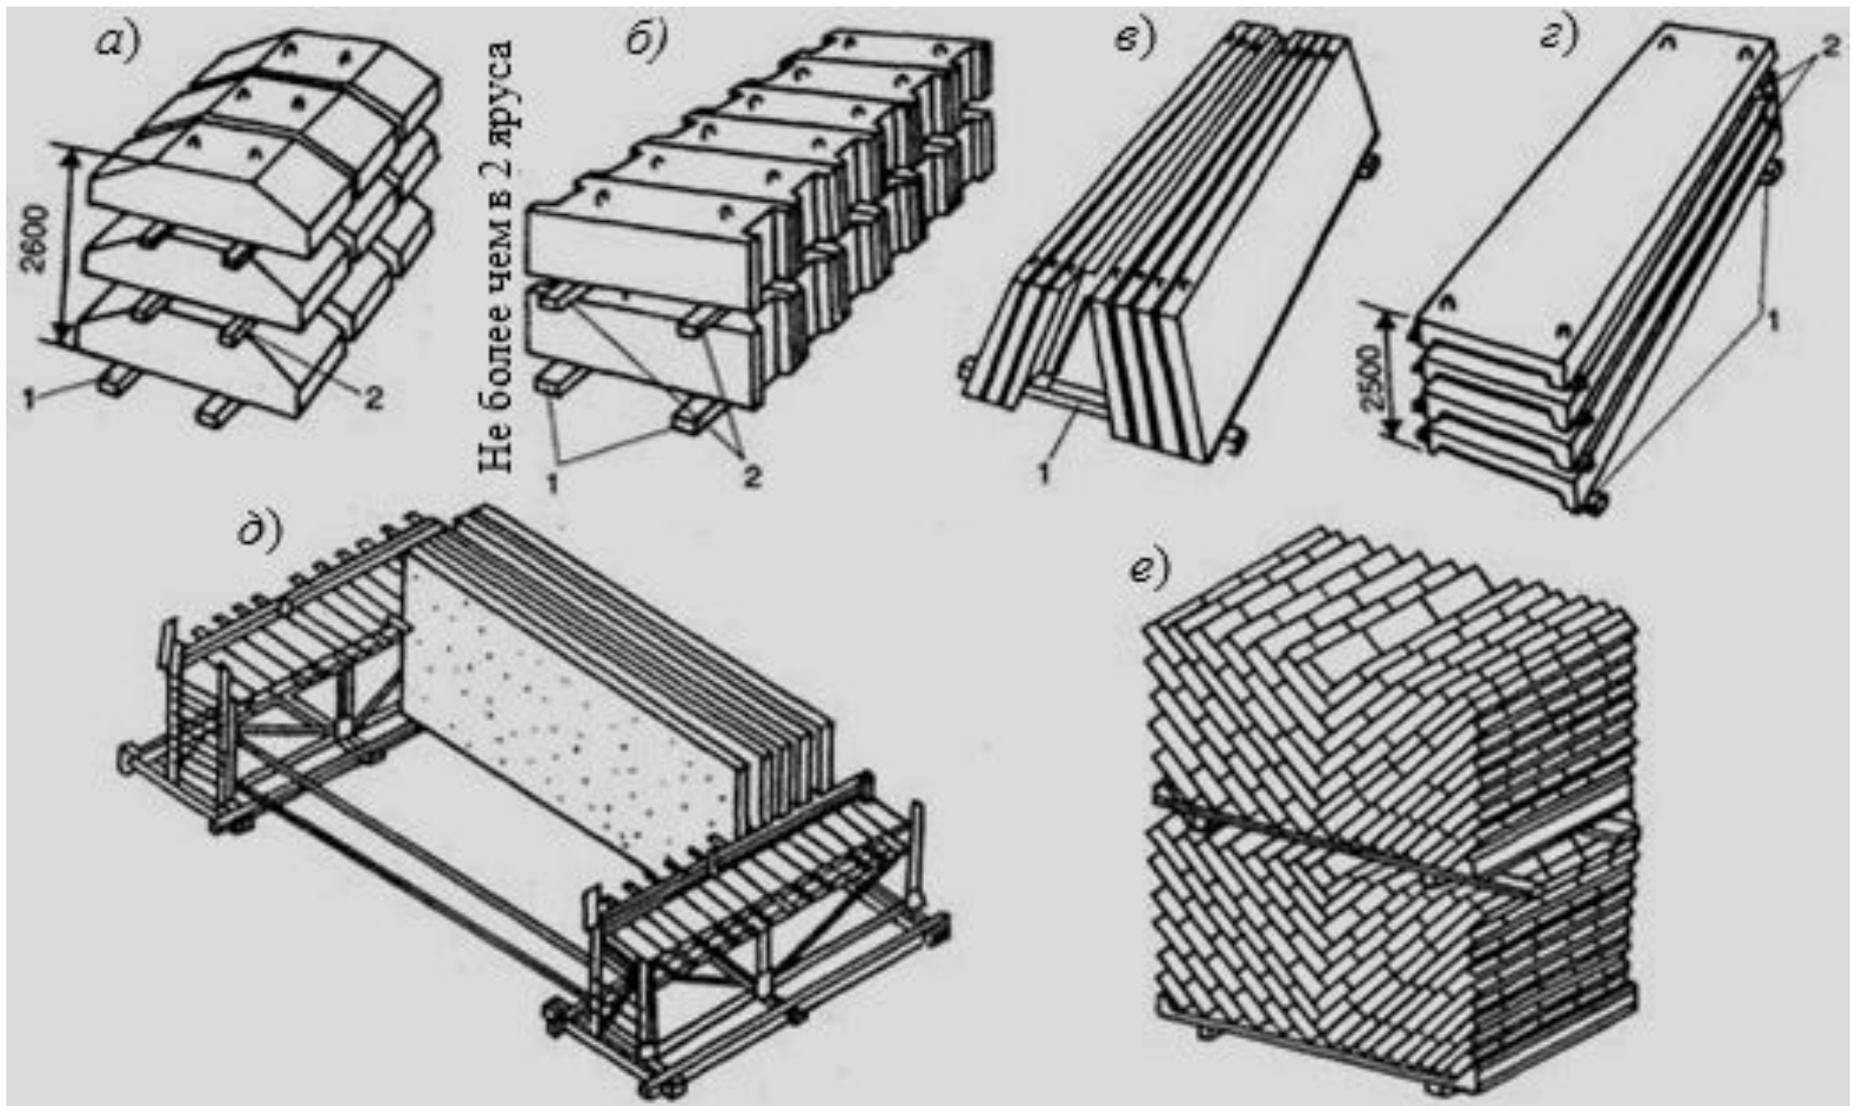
Схема складирования железобетонных блоков и кирпича на поддонах:
